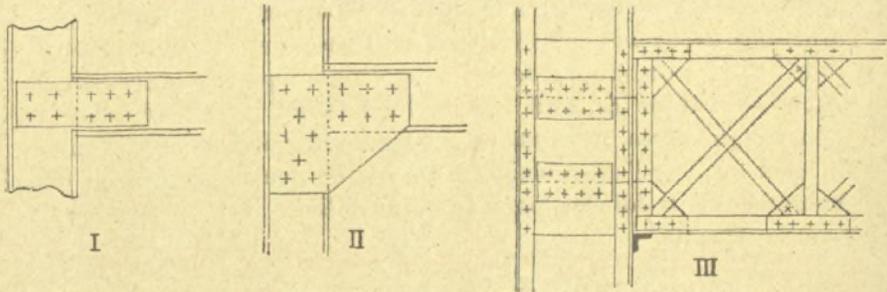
Modes d'assemblages d'une poutre sur un poteau.
